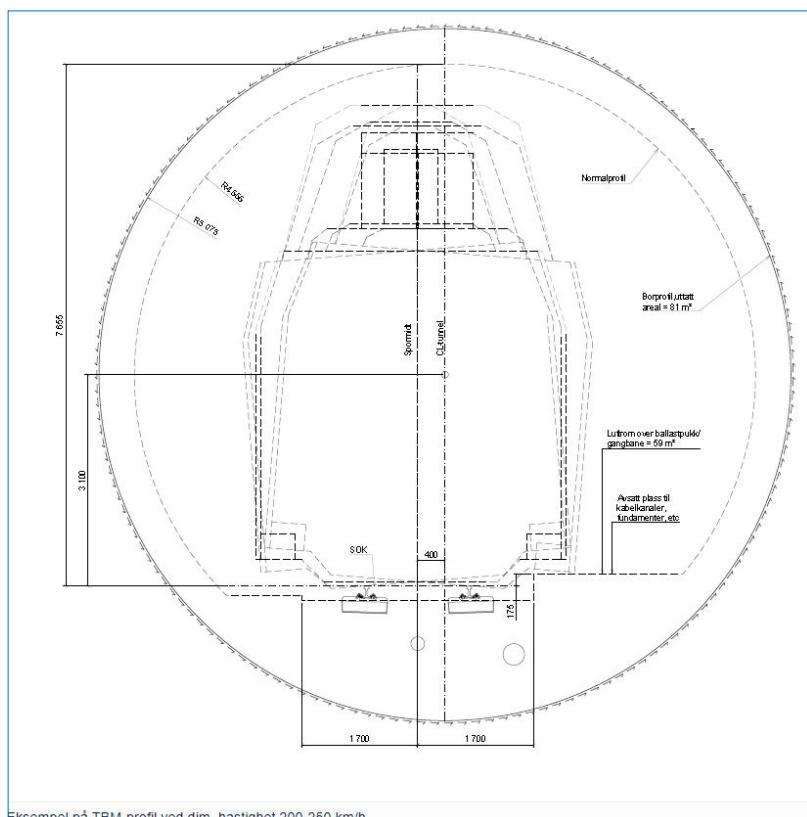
Figur 3-5 viser tversnitt for tunneler.
